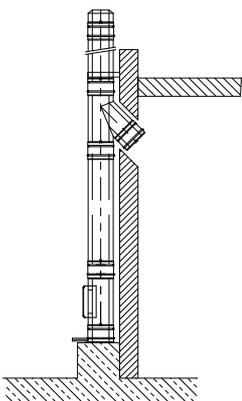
Aufbau mit Grundplatte für Sockelmontage
